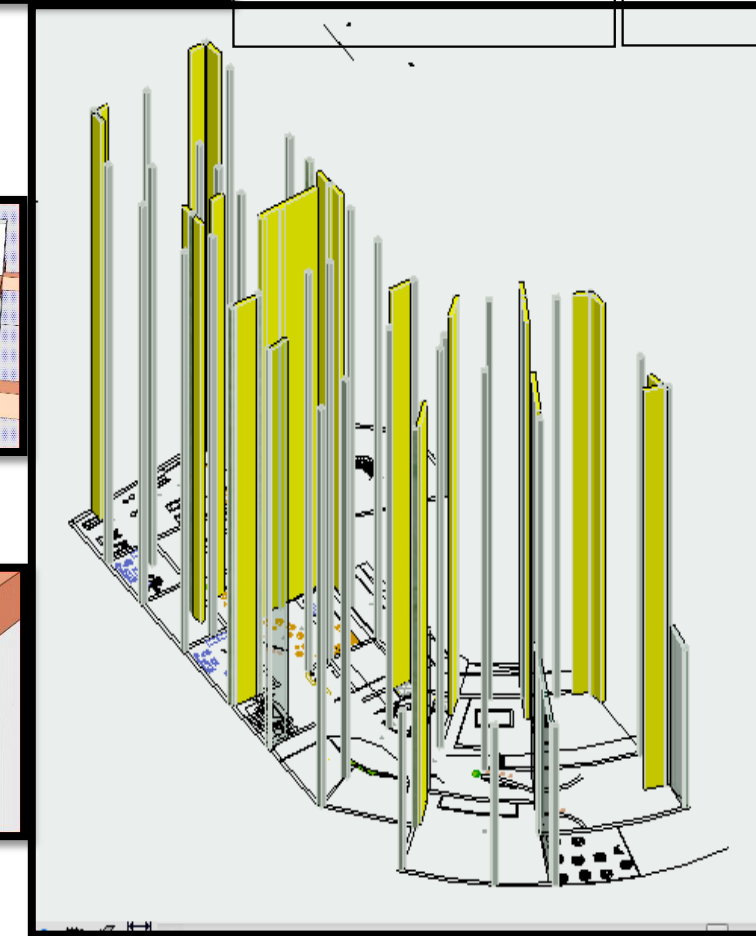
photo représente la stabilité et les renforcements de la structure; Src :auteur
